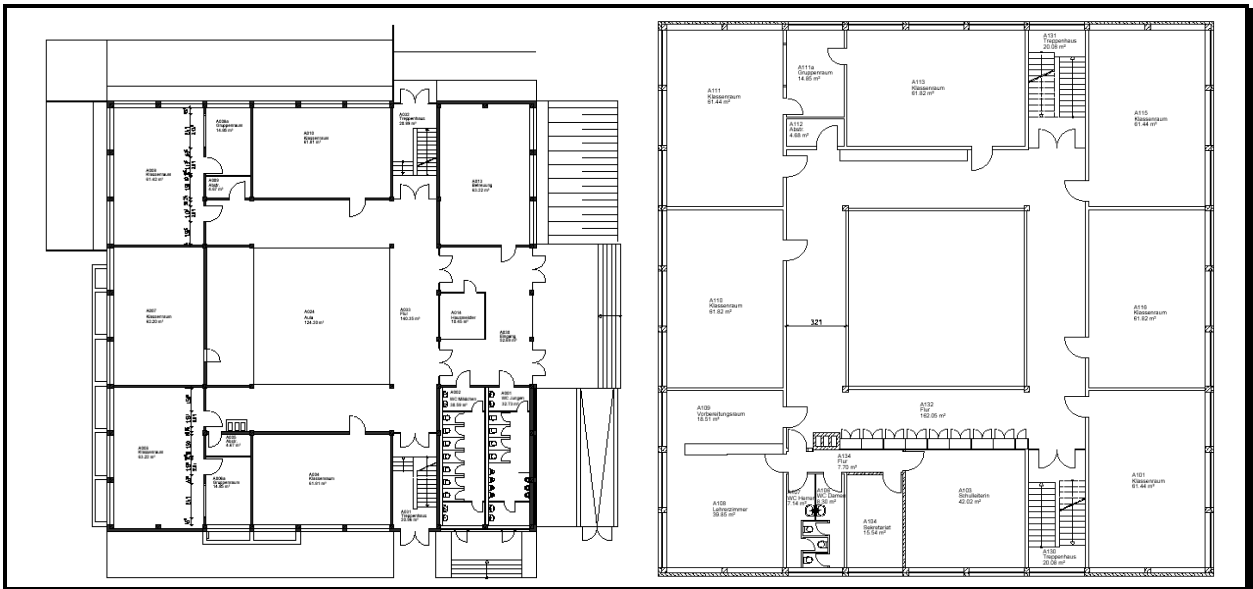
Brüder-Grimm Schule: Grundriss EG (li) und 1. OG (re) Schule
